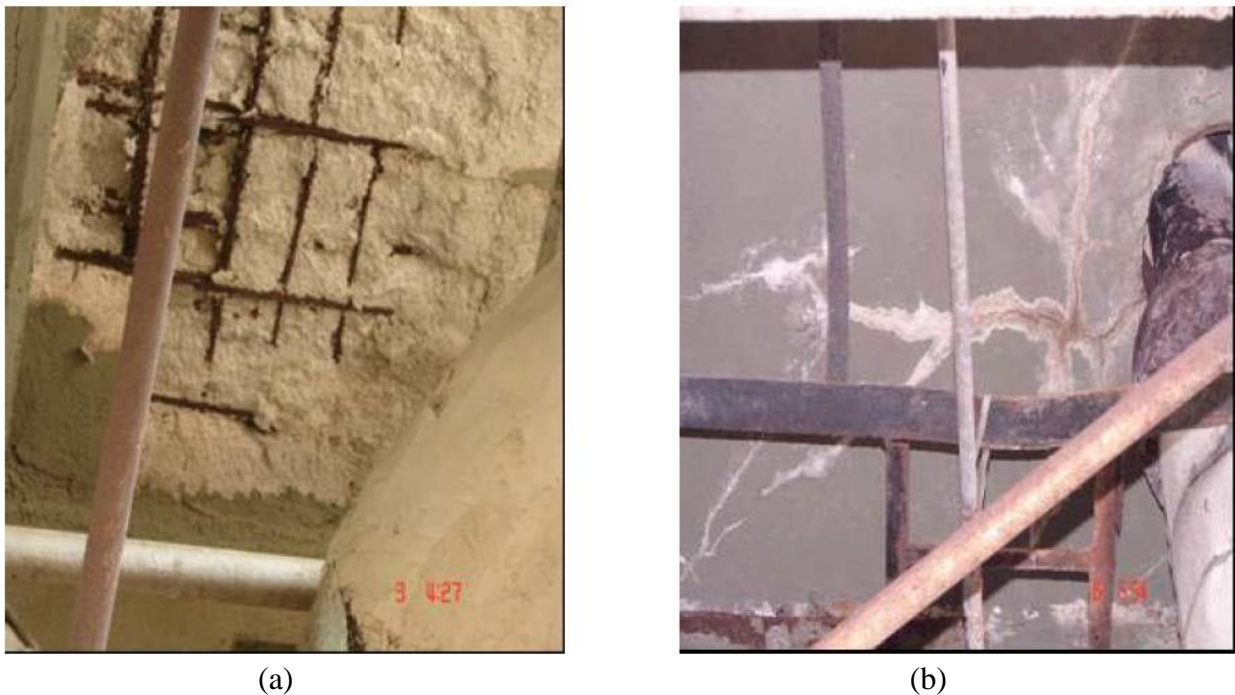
Levantamiento fotográfico de la losa a) Delaminación del concreto con acero expuesto, con corrosión severa. b) Agrietamiento de la losa con manchas por lixiviación y percolación del concreto.
